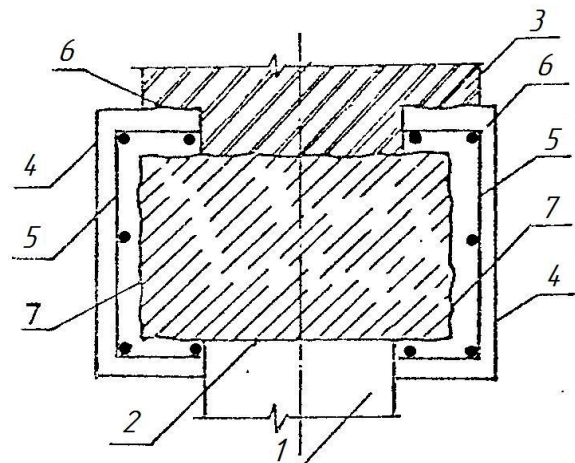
Улаштування залізобетонної сорочки з боків ростверка: 1 – залізобетонна паля; 2 – залізобетонний посилюваний ростверк; 3 – існуюча кам'яна стіна; 4 – залізобетонна сорочка; 5 – арматурні П-подібні каркаси; 6 – пази, вирубані в стіні для улаштування сорочки; 7 – поверхня ростверка, підготовлена до бетонування
